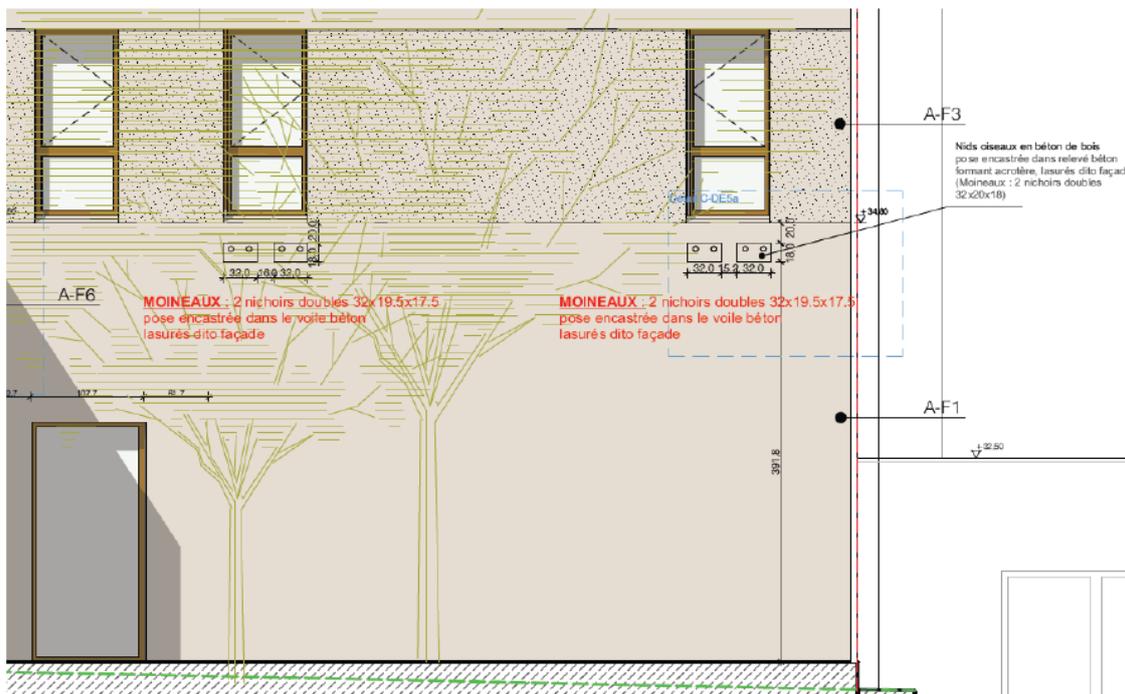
mise à jour du nombre de nichoirs à moineaux sur la tranche 1, avant démolition - reprise de la figure 32
